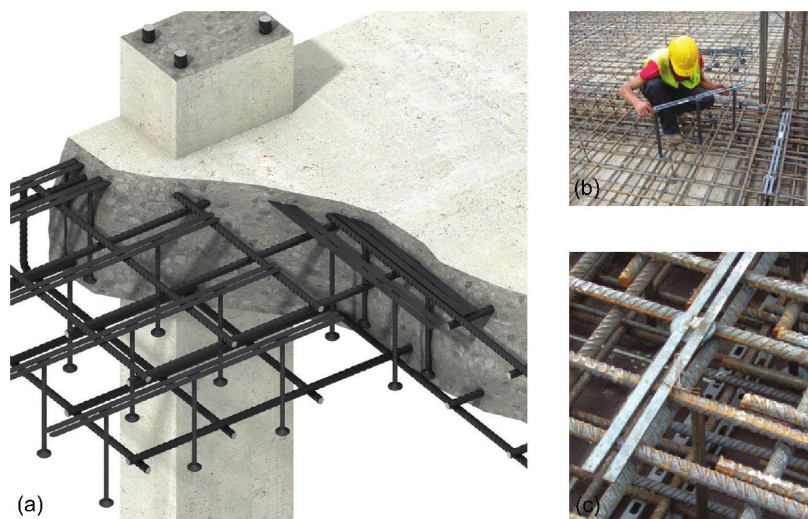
Sistema de armaduras de punçoamento "Ancon shearfix": (a) Posicionamento das armaduras; (b) Colocação em obra; (c) Pormenor da fixação na armadura de flexão [3].
